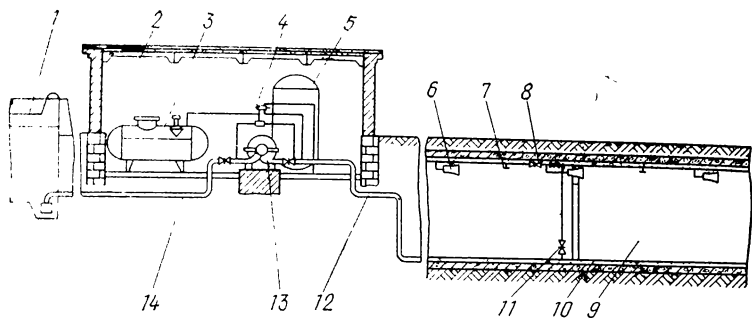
Пенная установка пожаротушения кабельного туннеля
